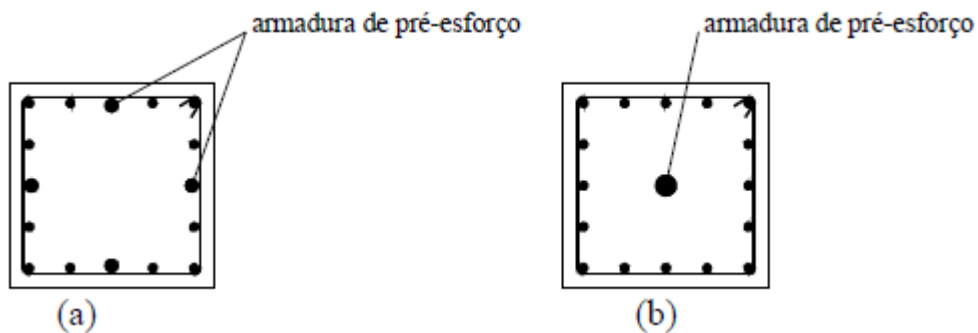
Localização da armadura de pré-esforço (pré-esforço uniforme) [9]
